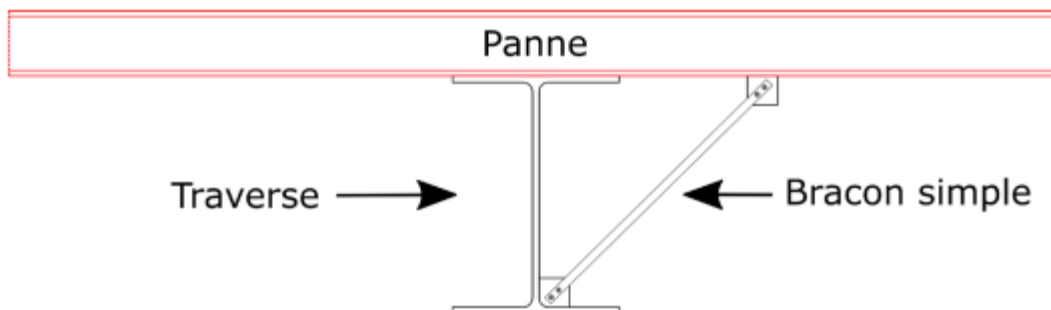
Maintien des semelles de la traverse – Coupe A-A
